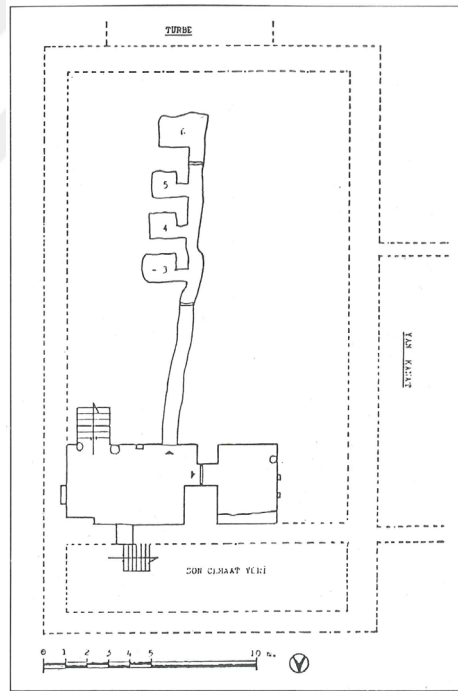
Hacı Bayram Camii zemin kadınlar mahfil planı (Başkan, 1998: 19)
